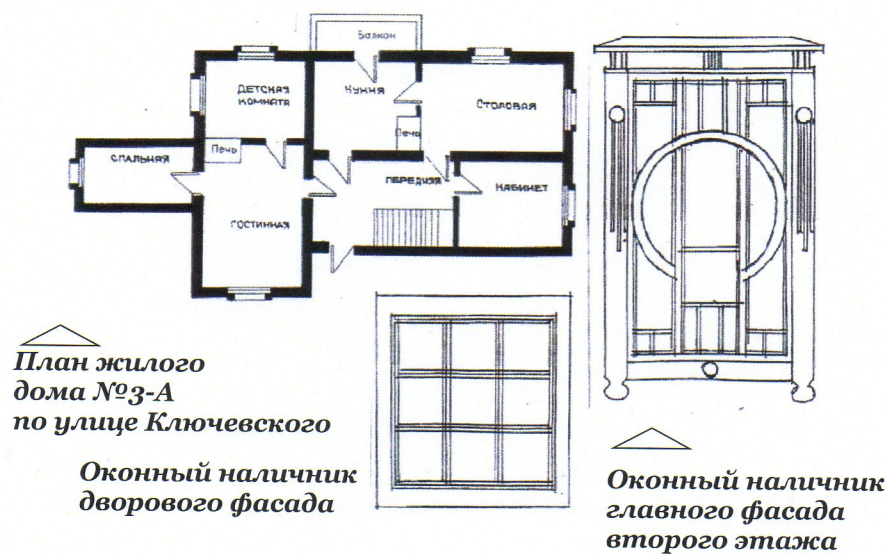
Ул. Ключевского, 3а. План-схема здания. Элементы фасада.
